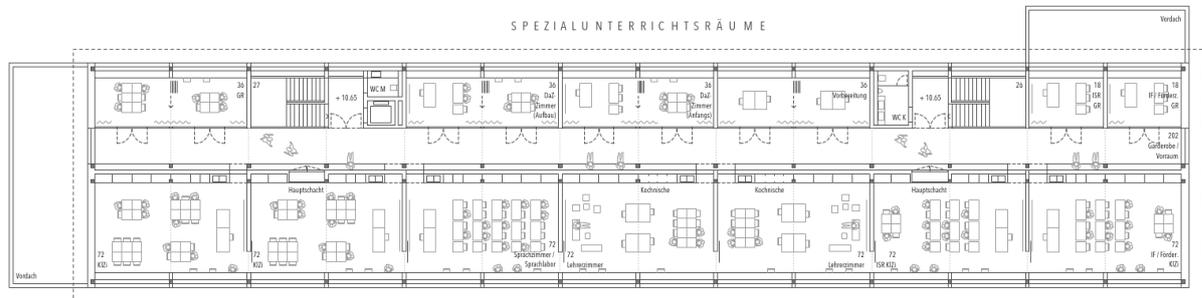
Grundriss Neubau Sekundarschule, 3. Obergeschoss
